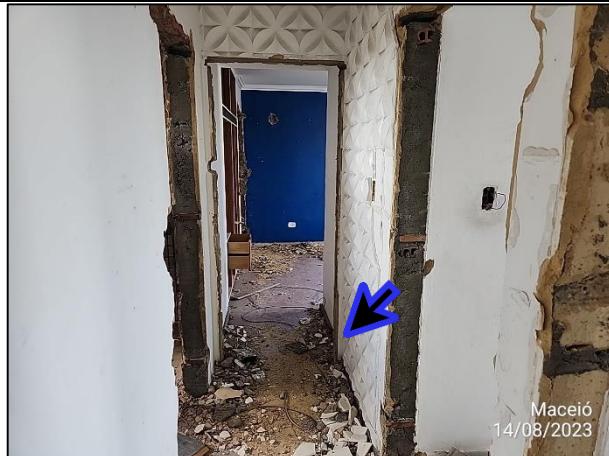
Vista em plano geral corrosão – Pilar – Sala de Força – Bloco A – Mai/2023	 Foto 7 - Vista em plano geral corrosão – Pilar – Sala de Força – Bloco A – Ago/2023
